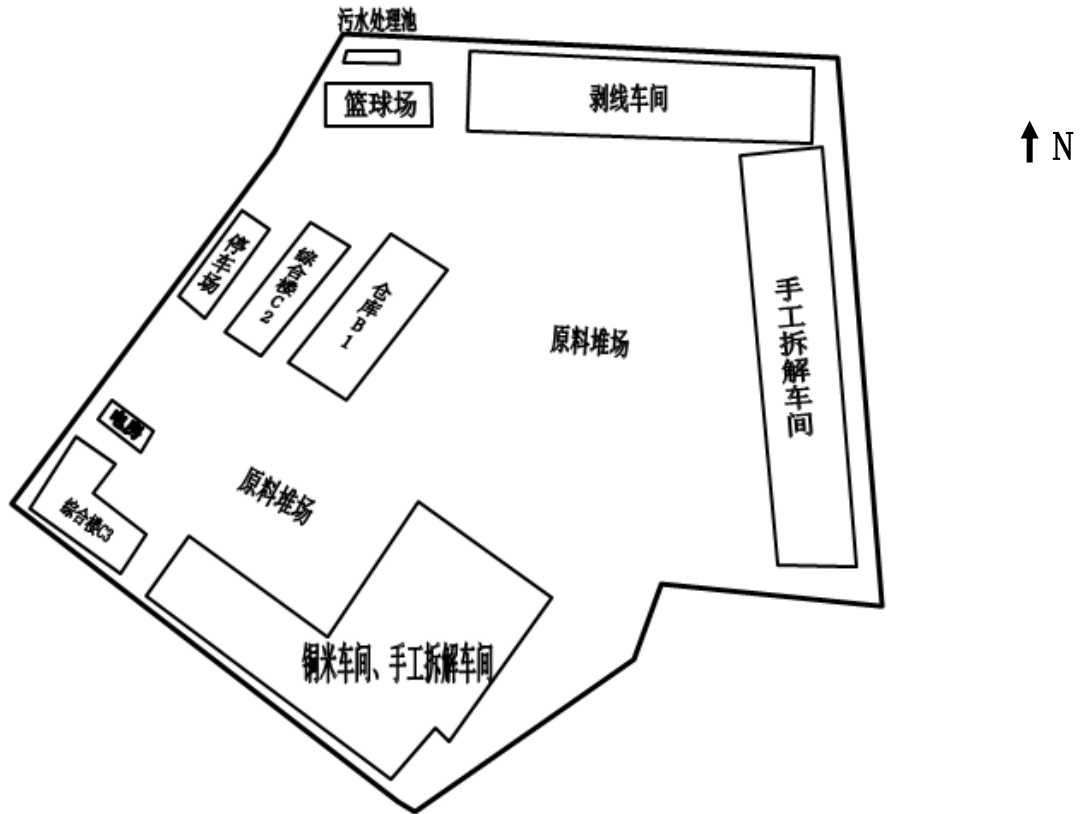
环评规划厂区平面布置图 (1:1200)
